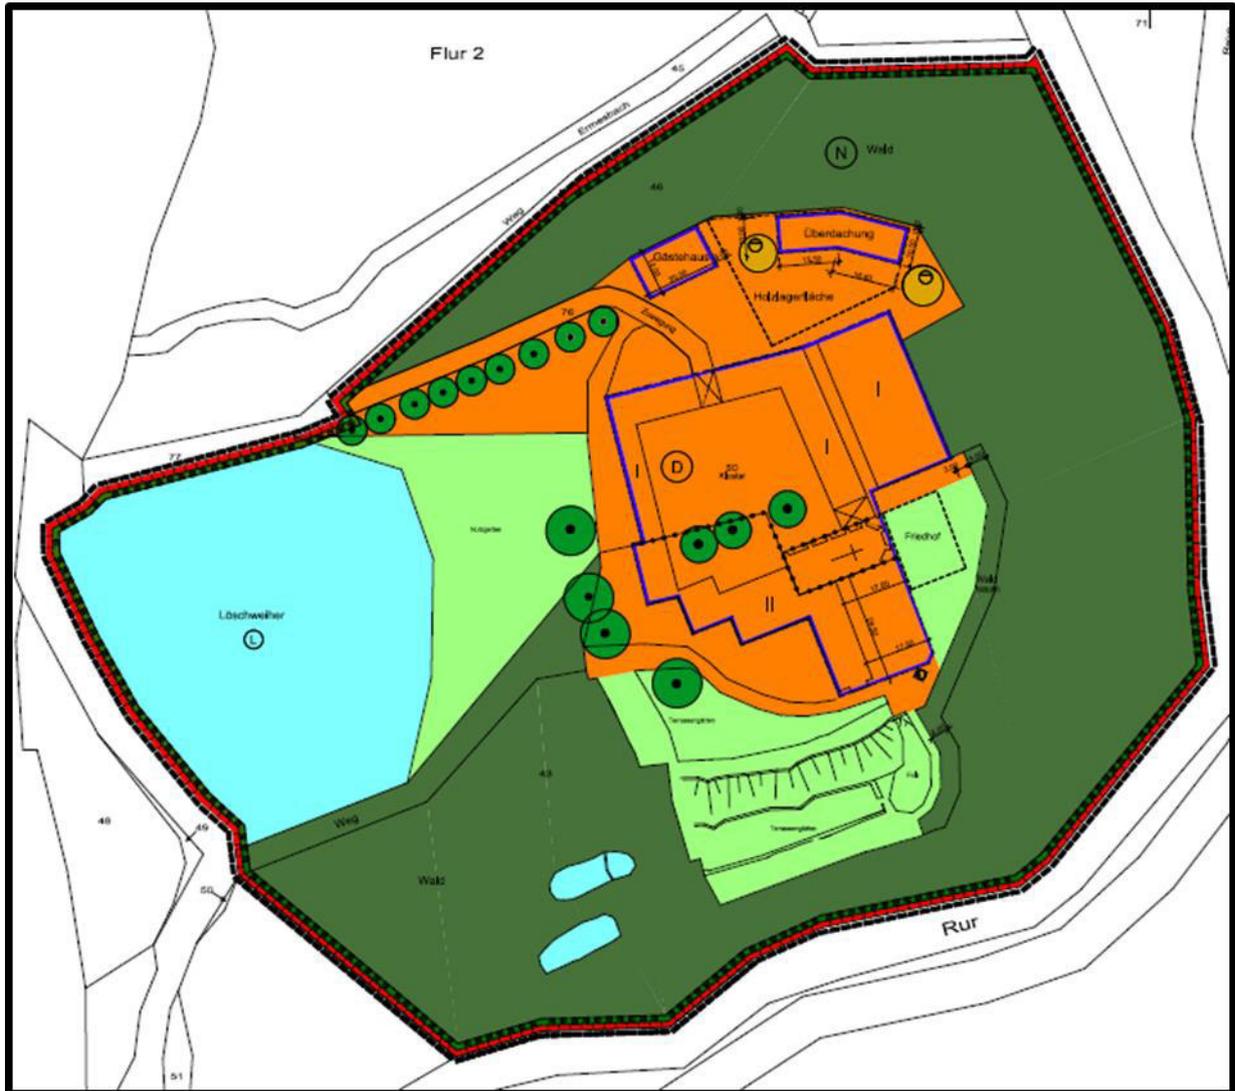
B-Plan. Quelle: Krings Architektur + Stadtplanung. Stand: 8.2016
